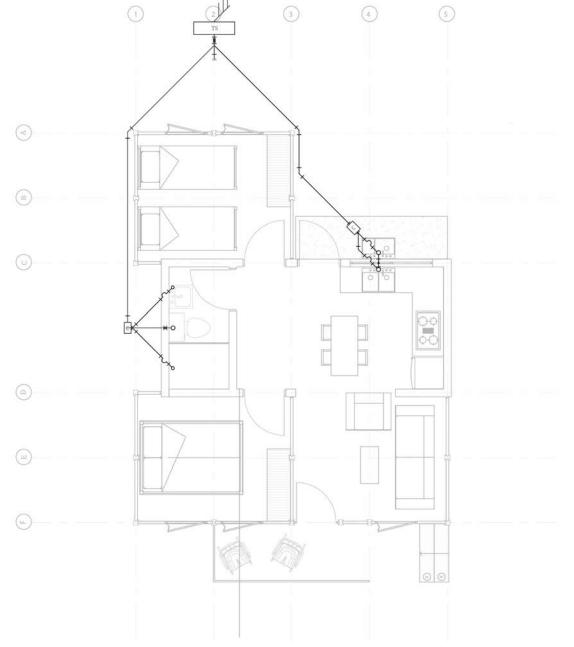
Planta Mecánica Vivienda Gran Área Metropolitana Fuente: Elaborado por autor
